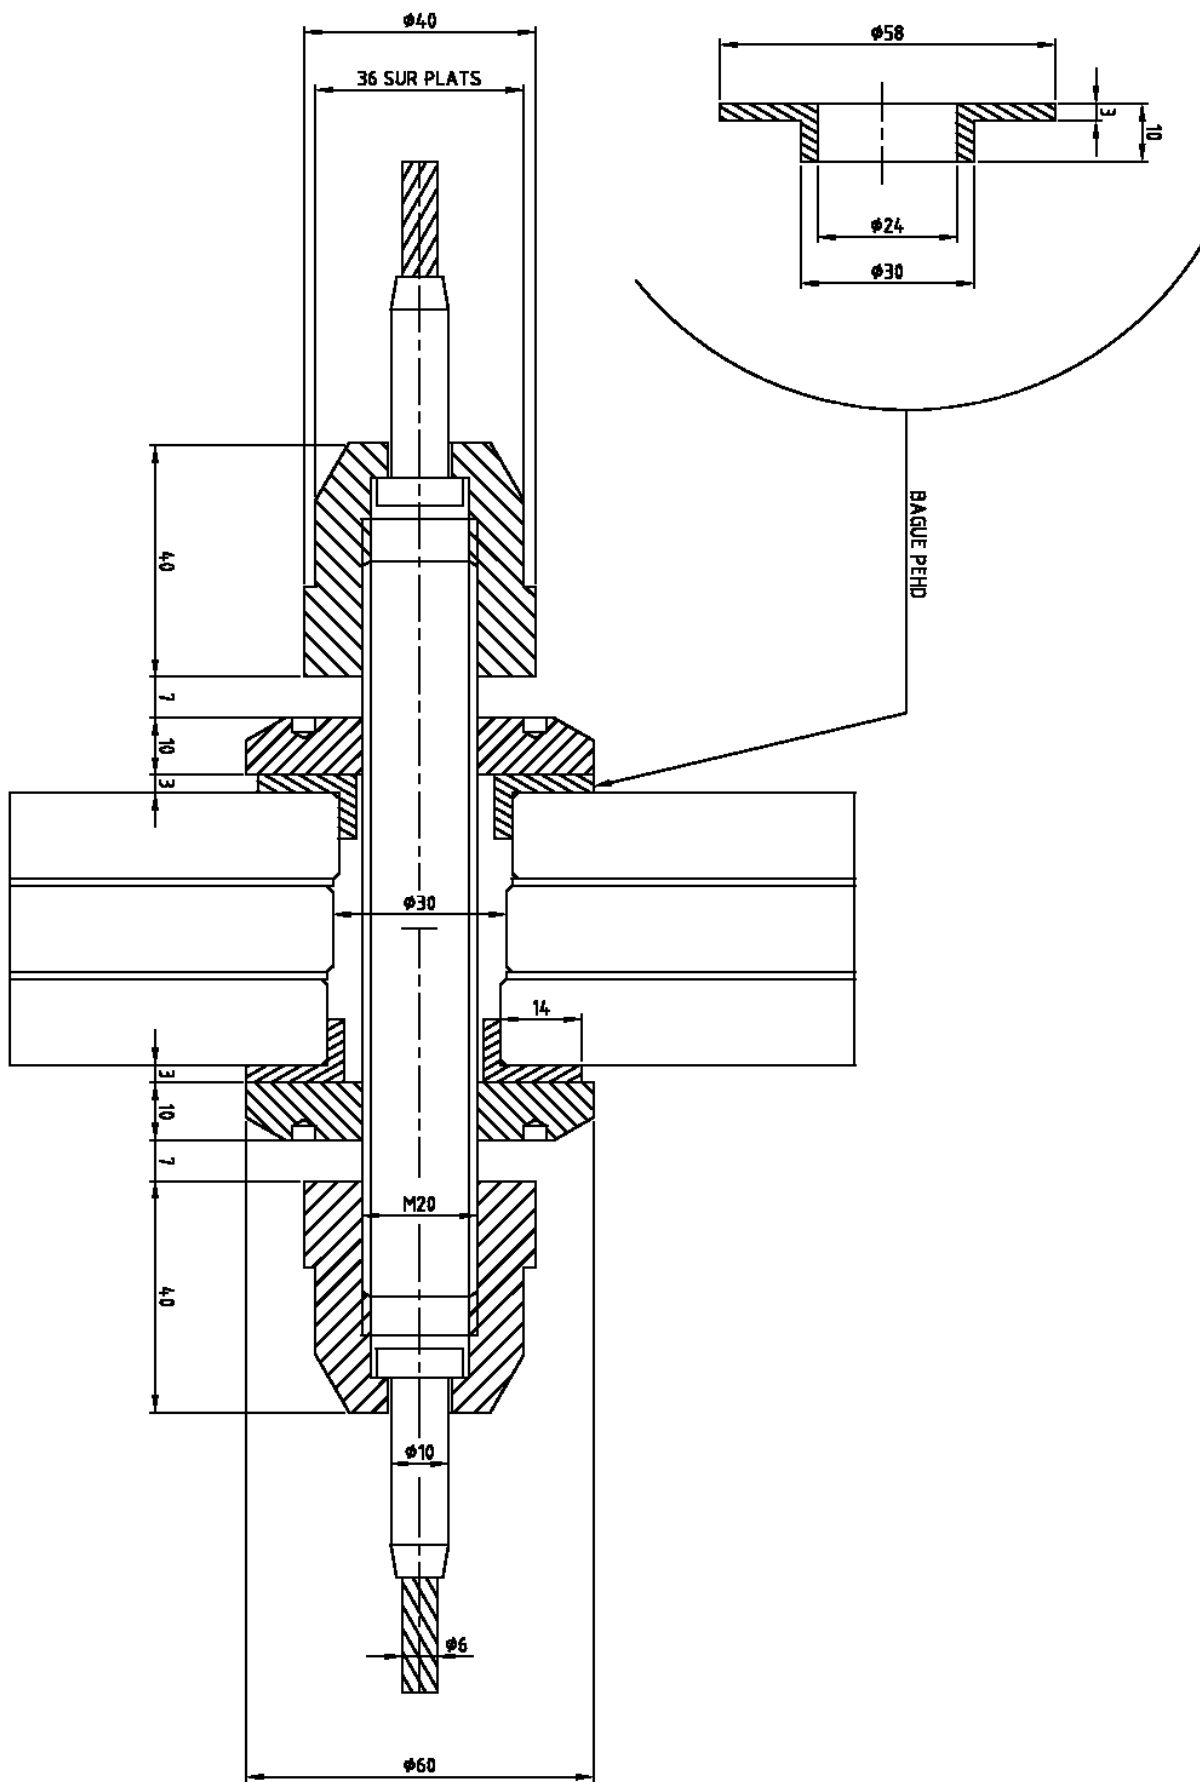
Principe de fixation du câble de stabilisation transversale sur les contreventements ou les consoles
